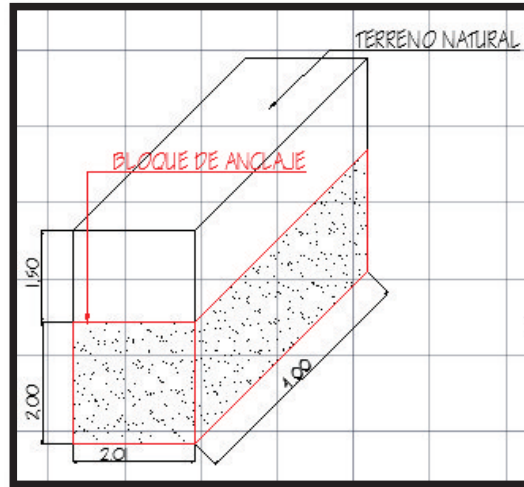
Macizo de anclaje de Hormigón Armado más suelo natural.
